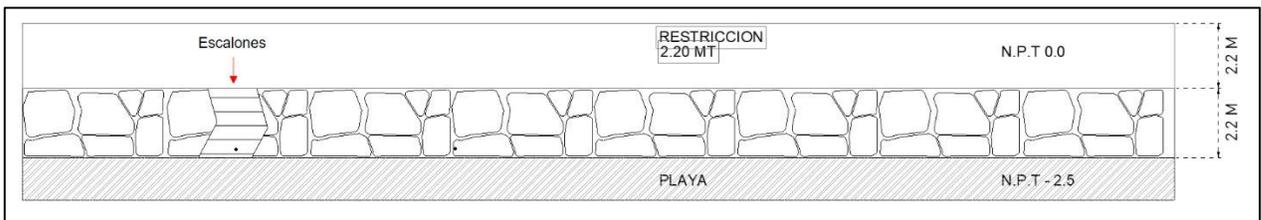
Vista frontal del muro de piedra colindante al litoral costero (dentro de la propiedad del solicitante), el cual también muestra un corte donde llevara un forjado de escalones de piedras sobre las rocas.
